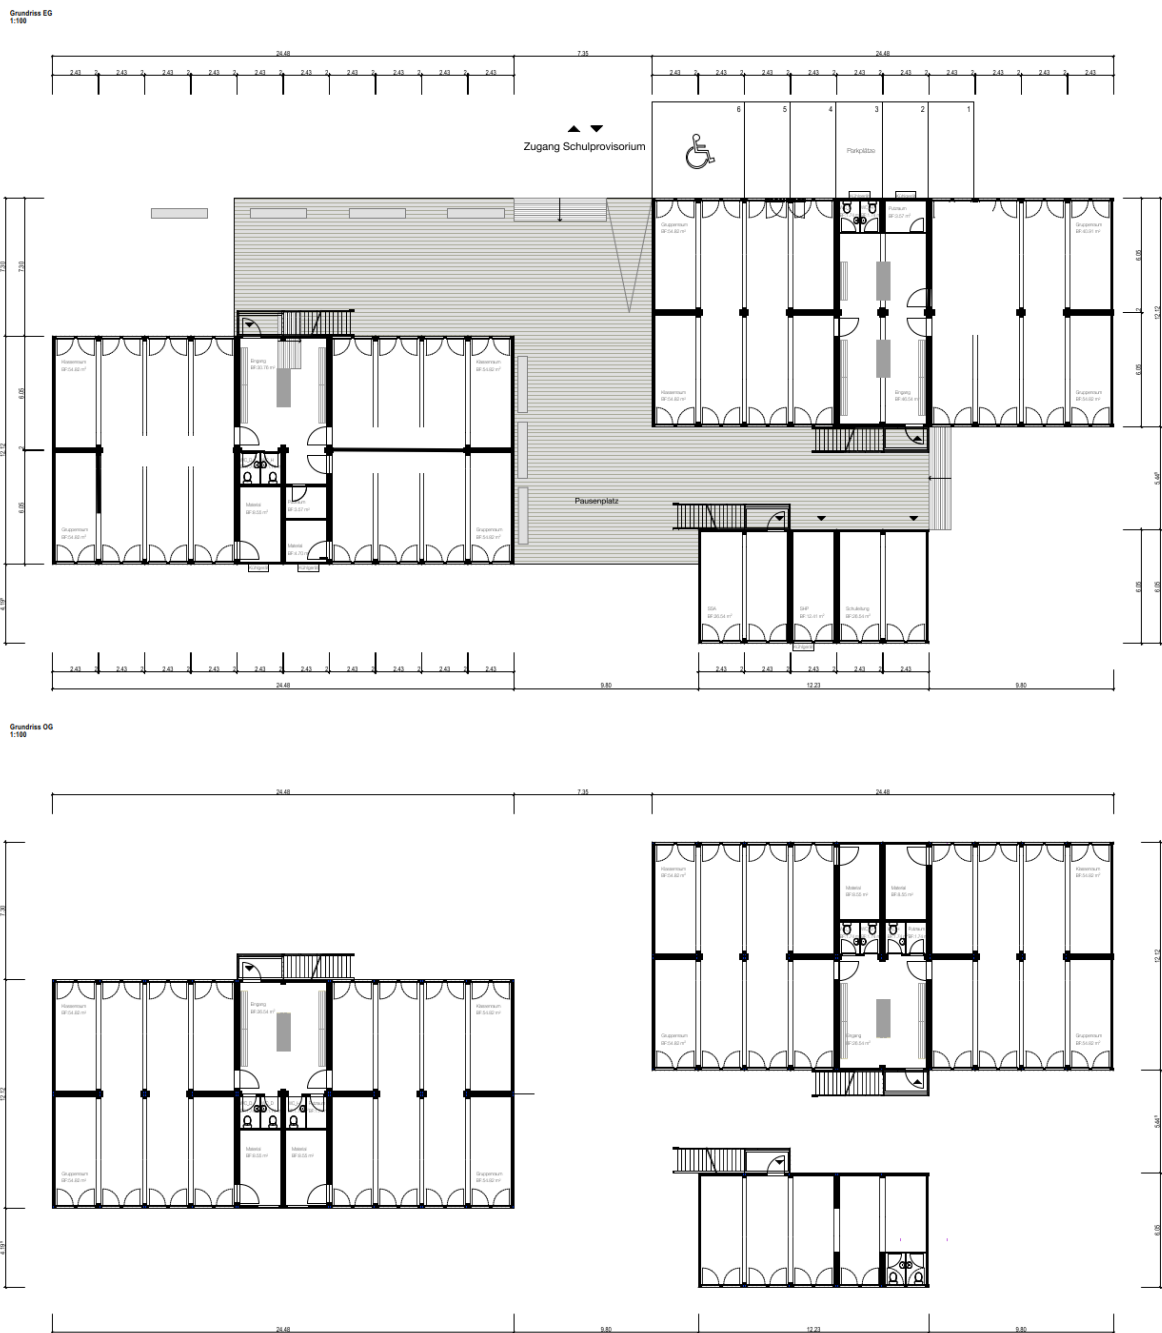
Grundrisse EG und 1.OG Machbarkeitsstudie
